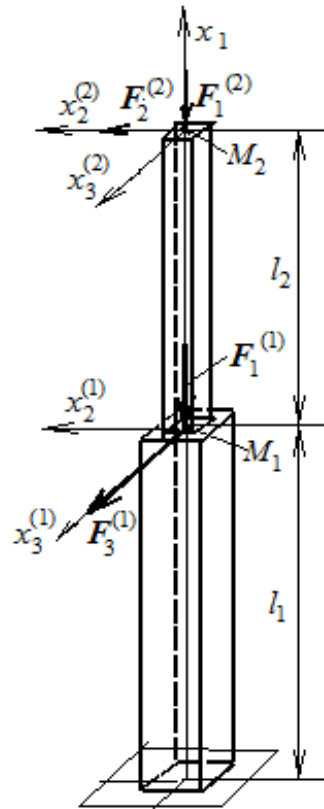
Схема железобетонной колонны с приложенной нагрузкой.
